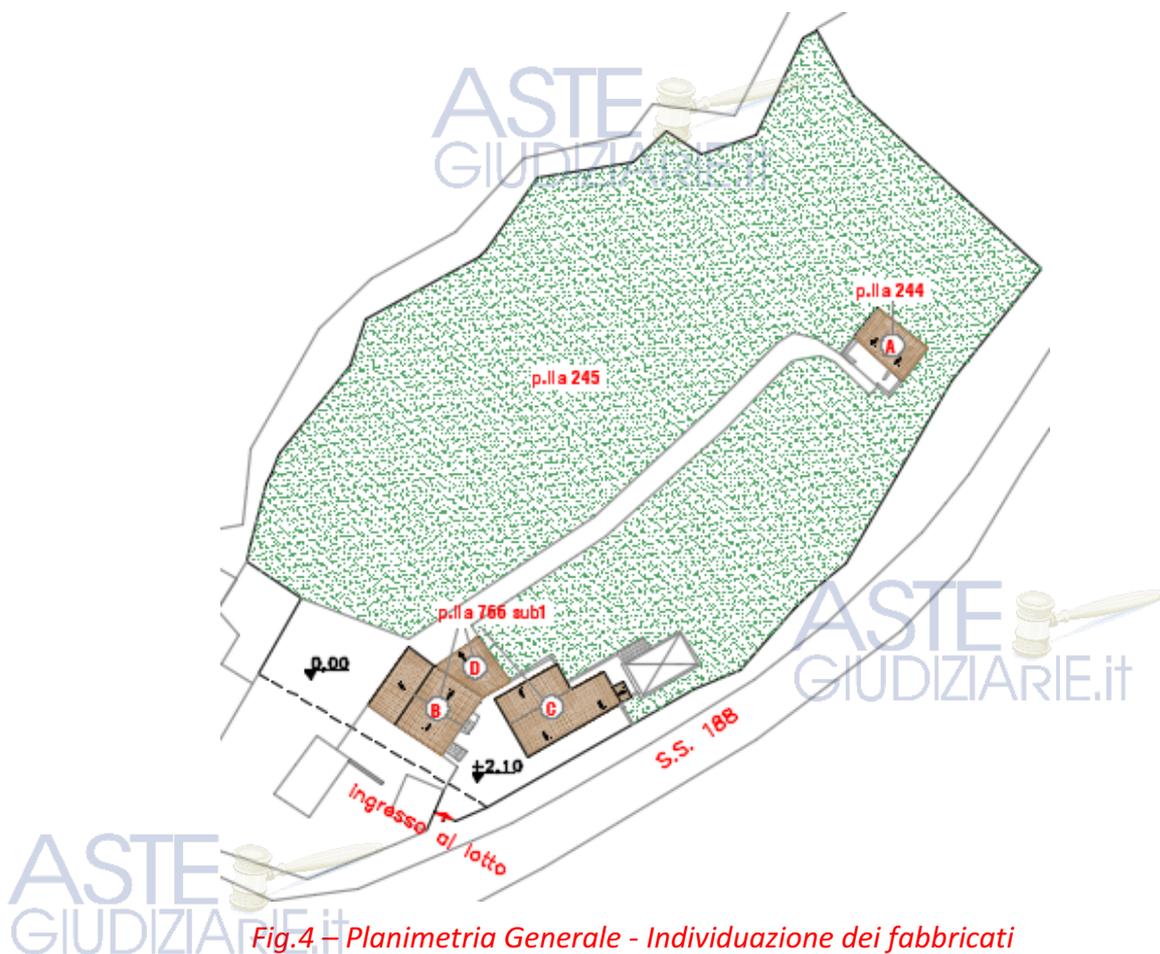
Planimetria Generale - Individuazione dei fabbricati
